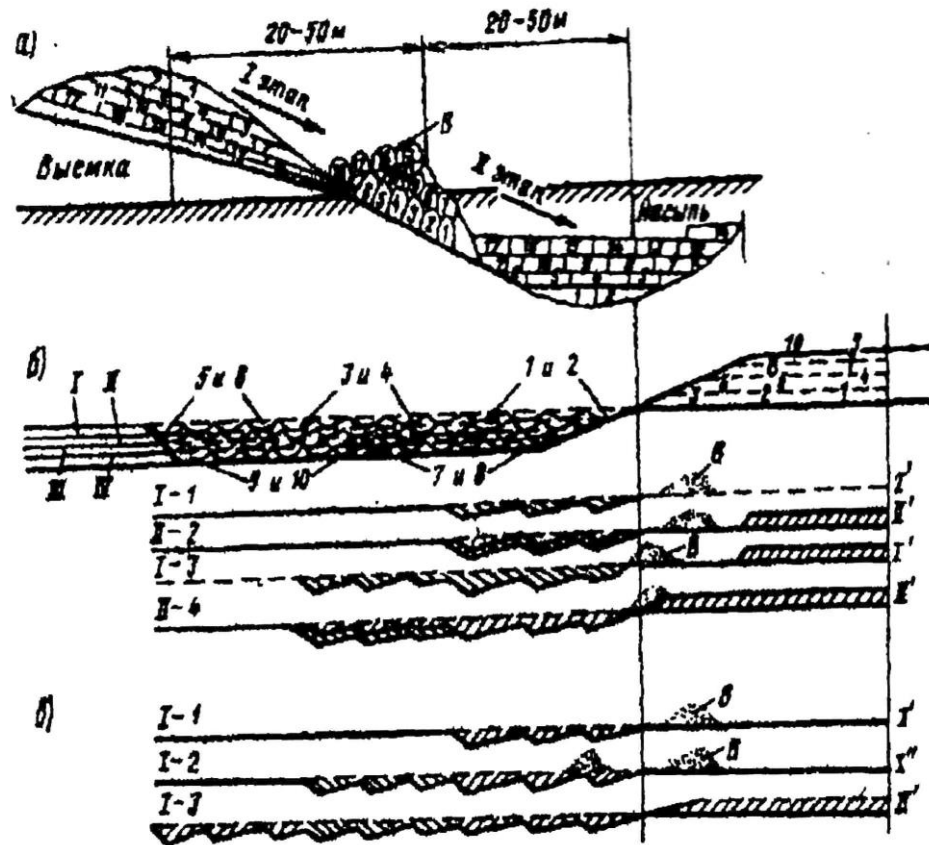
Схеми переміщення ґрунту бульдозером і траншеями
